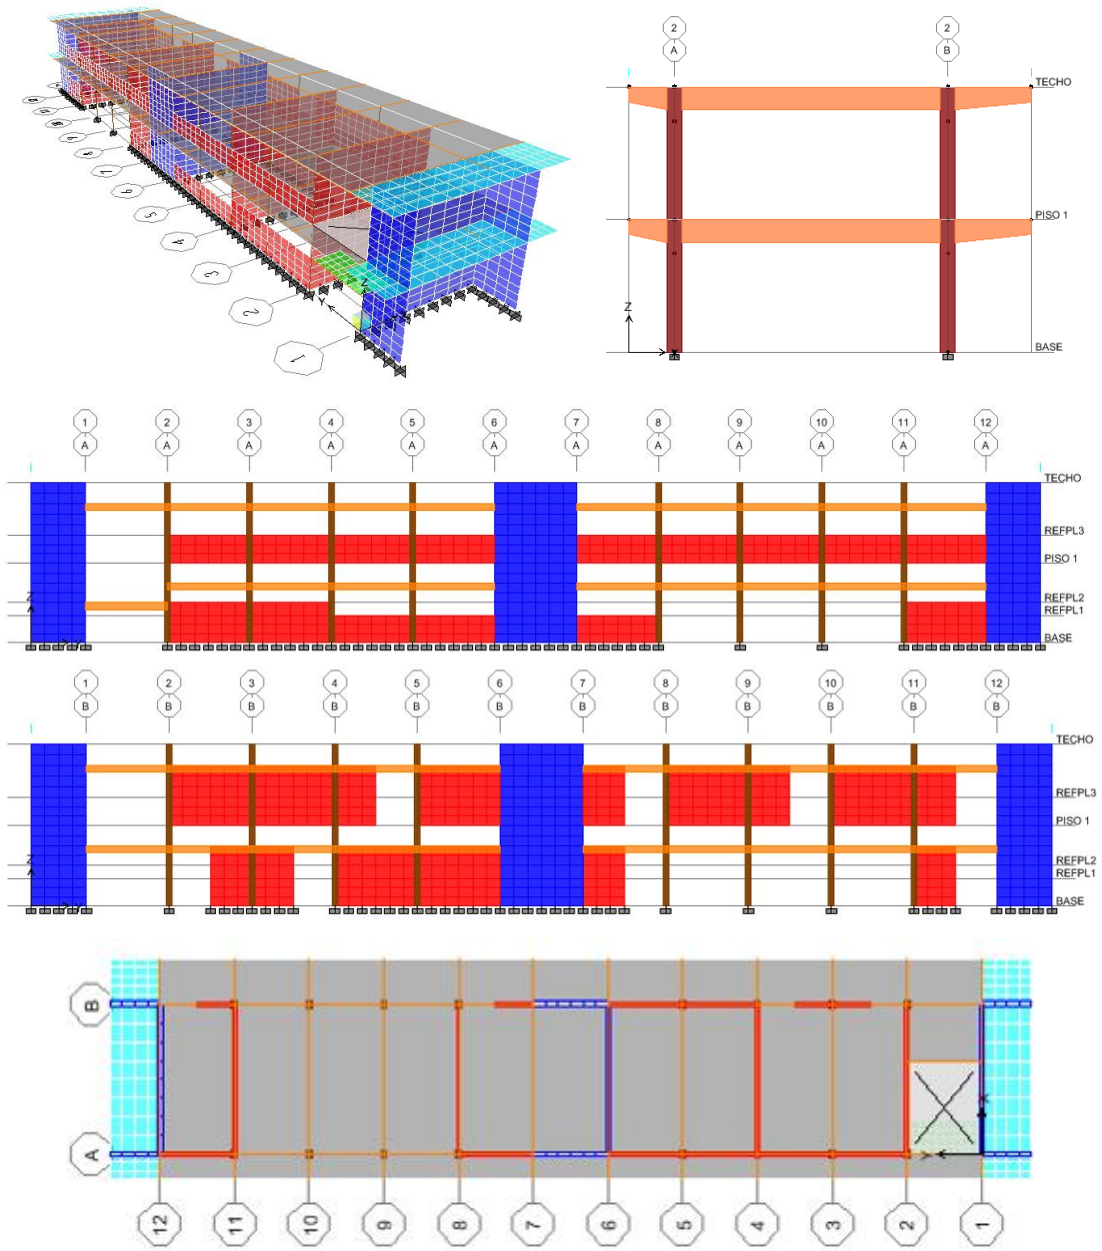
Vista 3D, Pórticos y Planta de los Modelos 7 y 8.
